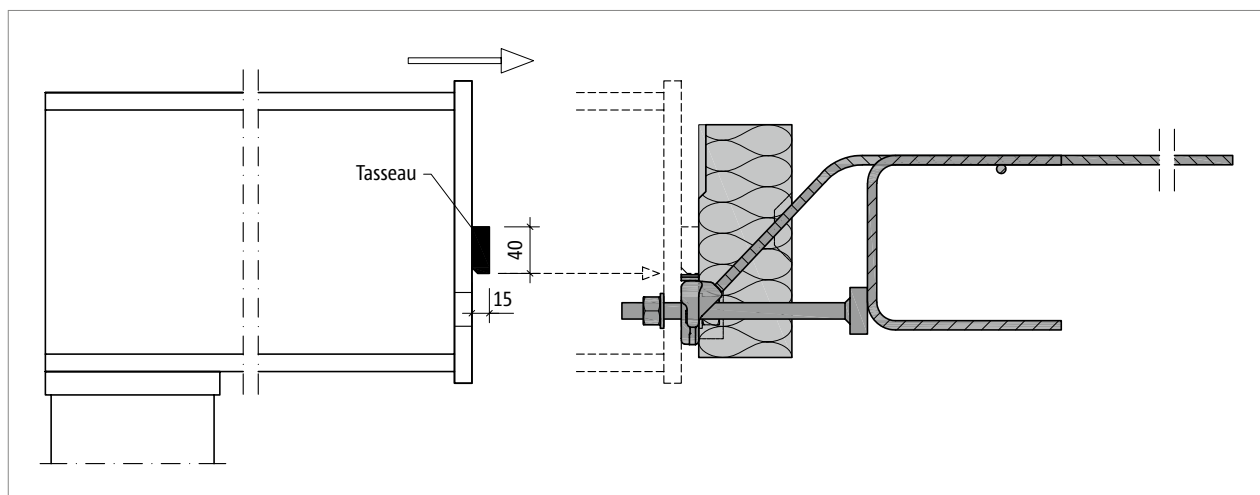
Schöck Isokorb® T type SQ : montage de la poutre en acier
